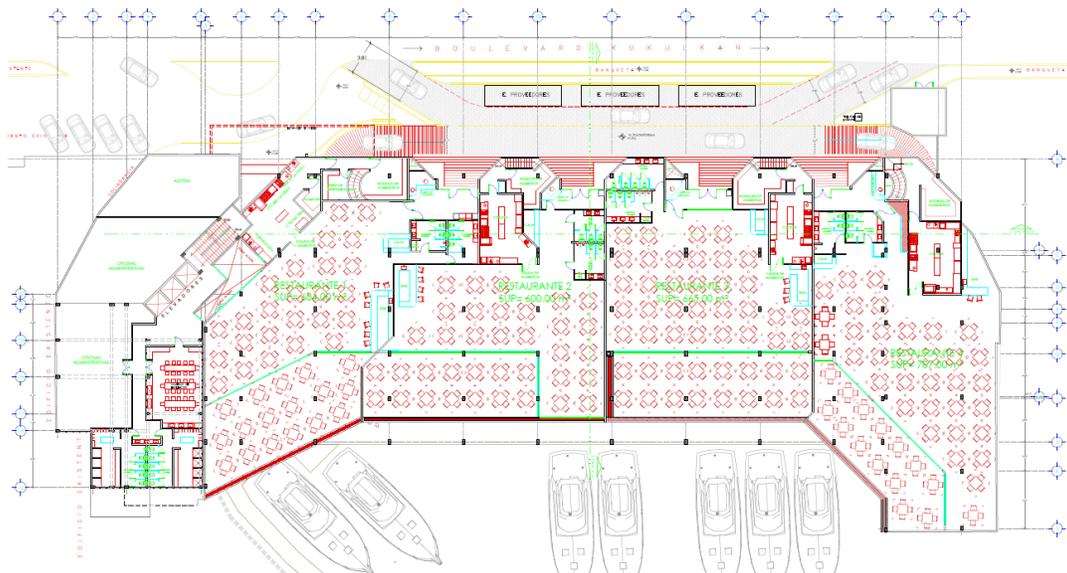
Imagen de la representación de la planta baja del proyecto. (Ver anexo digital)
